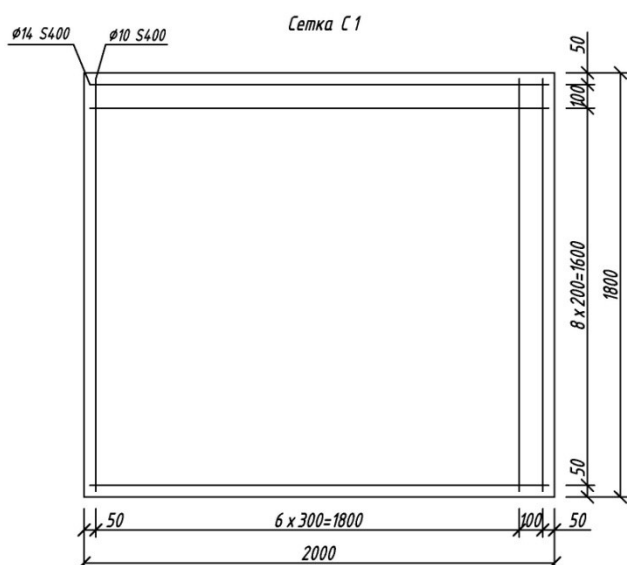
Схема для подсчета арматурных изделий в монолитном фундаменте
